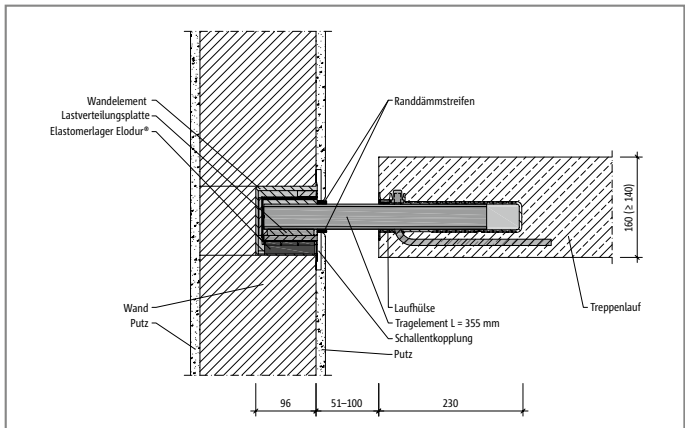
Schöck Tronsole® Typ Q-FV-XL oder Q-A2-XL: Einbausschnitt
